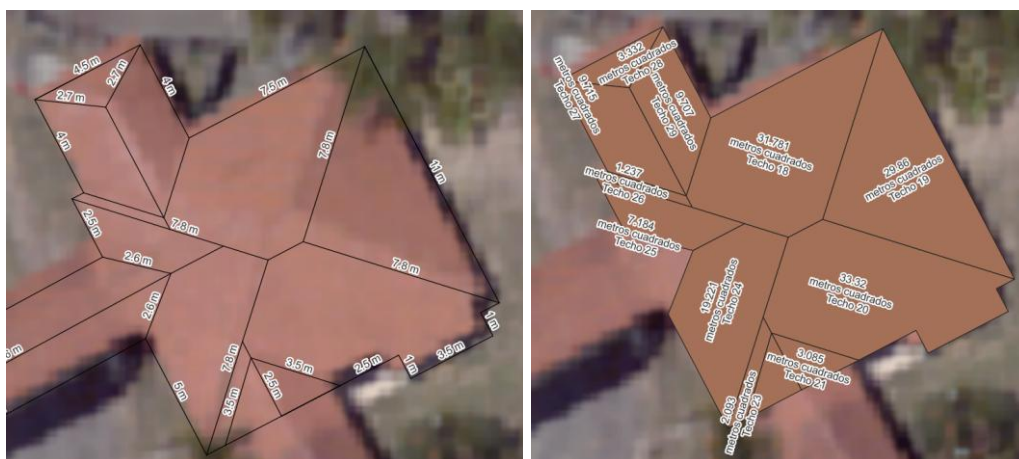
Dimensiones y Área de cubiertas Bloque 4
